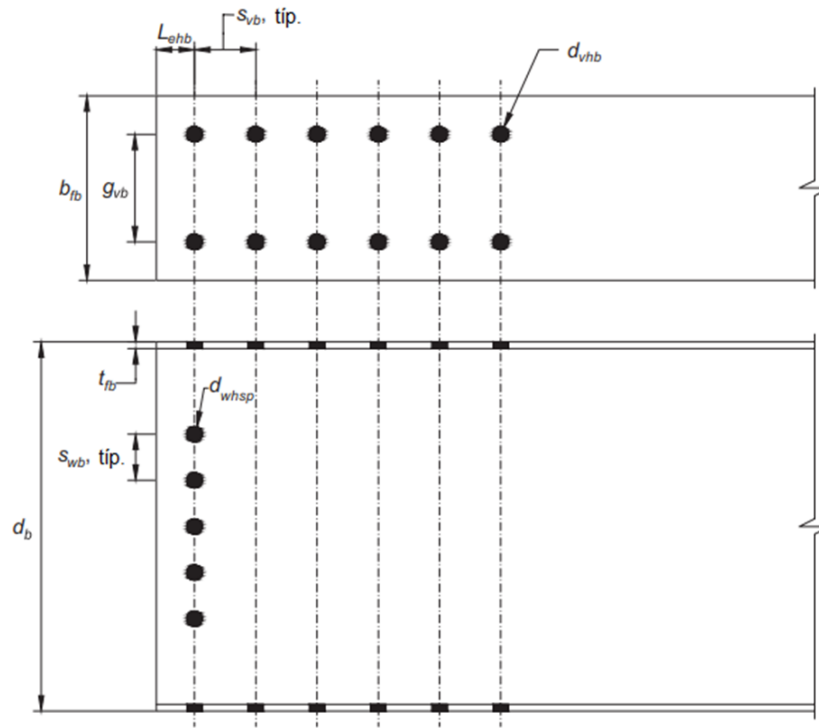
Dimensiones adicionales de la viga para conexiones Doble T.
